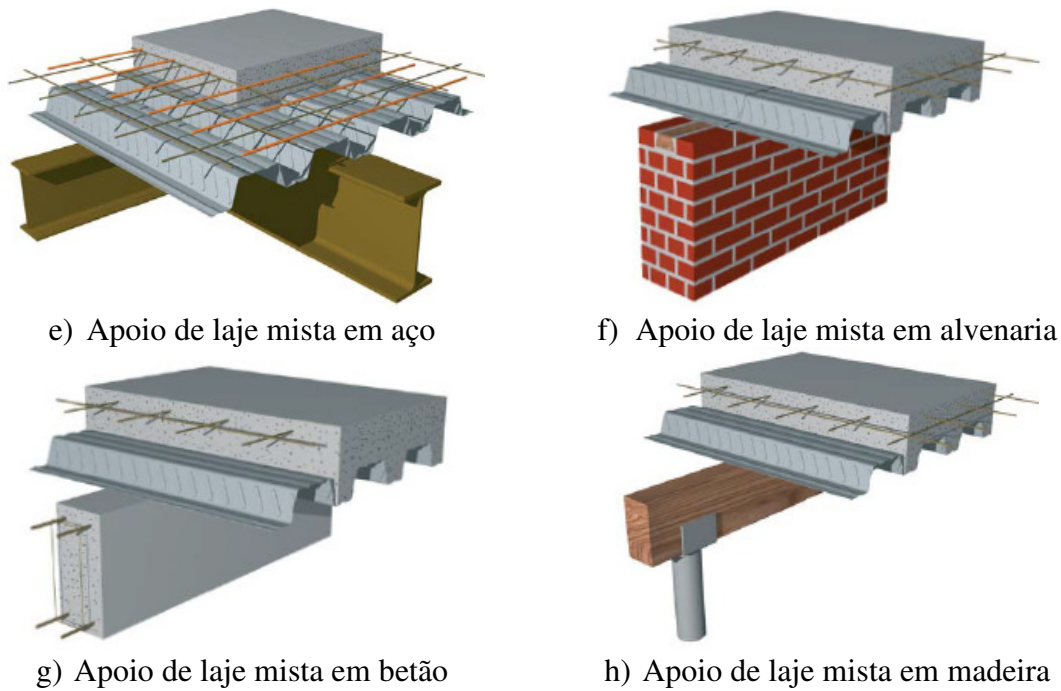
Disposições construtivas de lajes mistas (ArcelorMittal, 2009)
